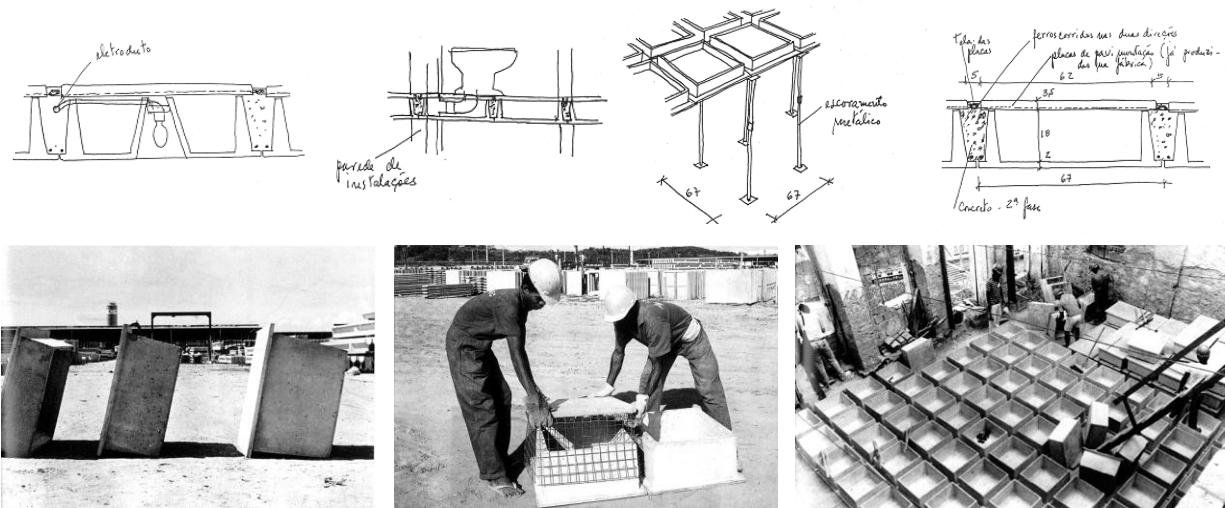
Lajes e divisórias pré-fabricadas: desenhos de Lelé, fabricação e montagem
